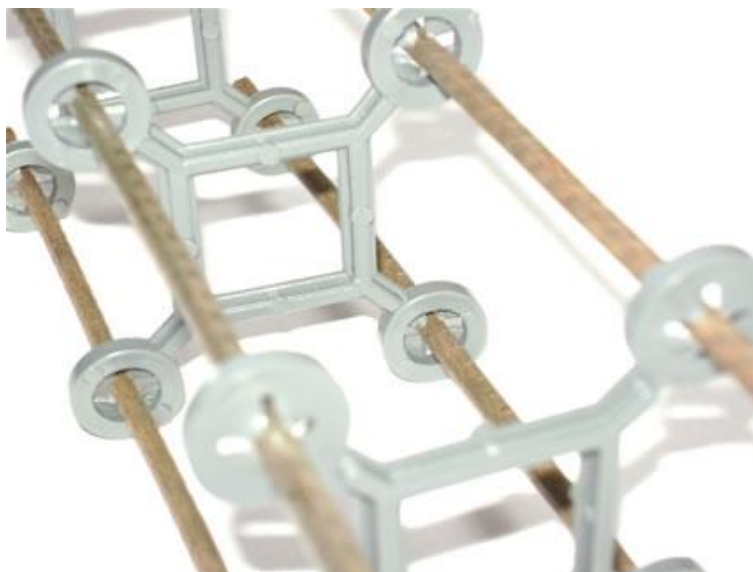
Espaçador utilizado para separar armaduras entre si (<http://www.maisplastico.com.br/>).
